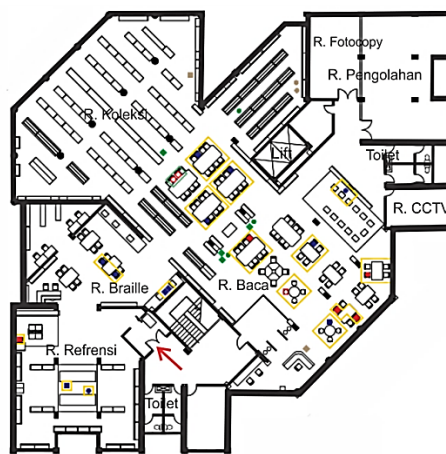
14 Denah Lantai 1 Perpustakaan Umum Kota Malang
